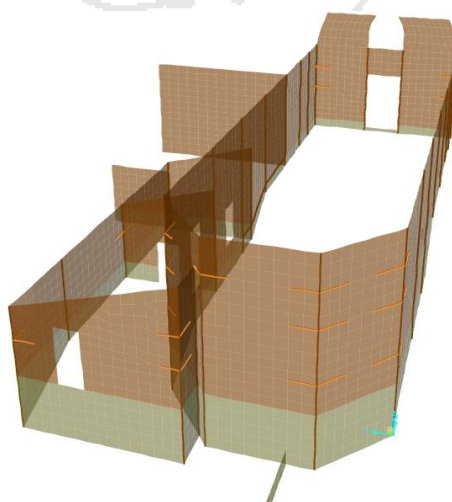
Ubicación del refuerzo llaves de madera en el modelo estructural.
